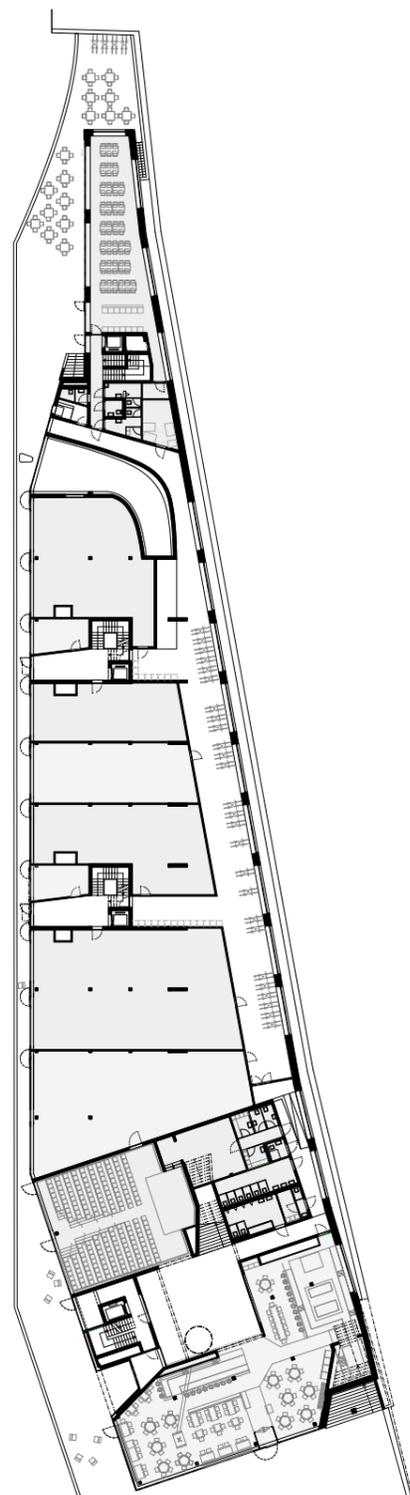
Planta do rés-do-chão do complexo de Zollhaus
